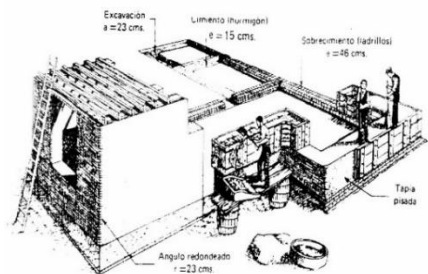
VISTA Y CONSTRUCCIÓN DE UNA CASA EN TAPIA PISADA.
